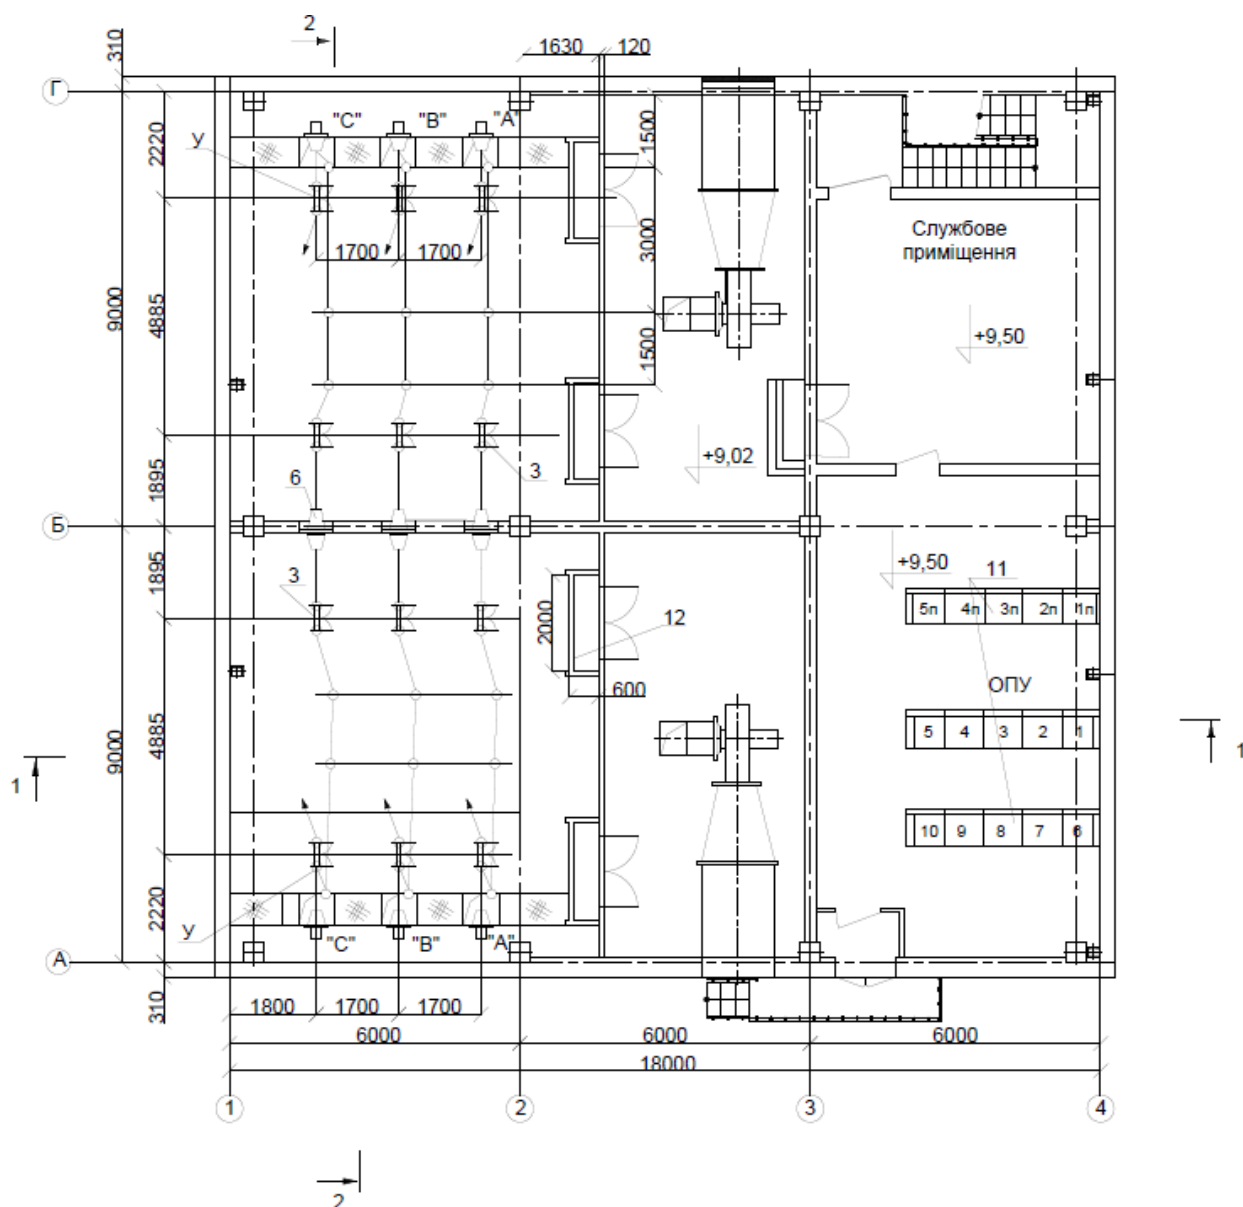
Існуючий план на відм +9,020 (третій поверх)
